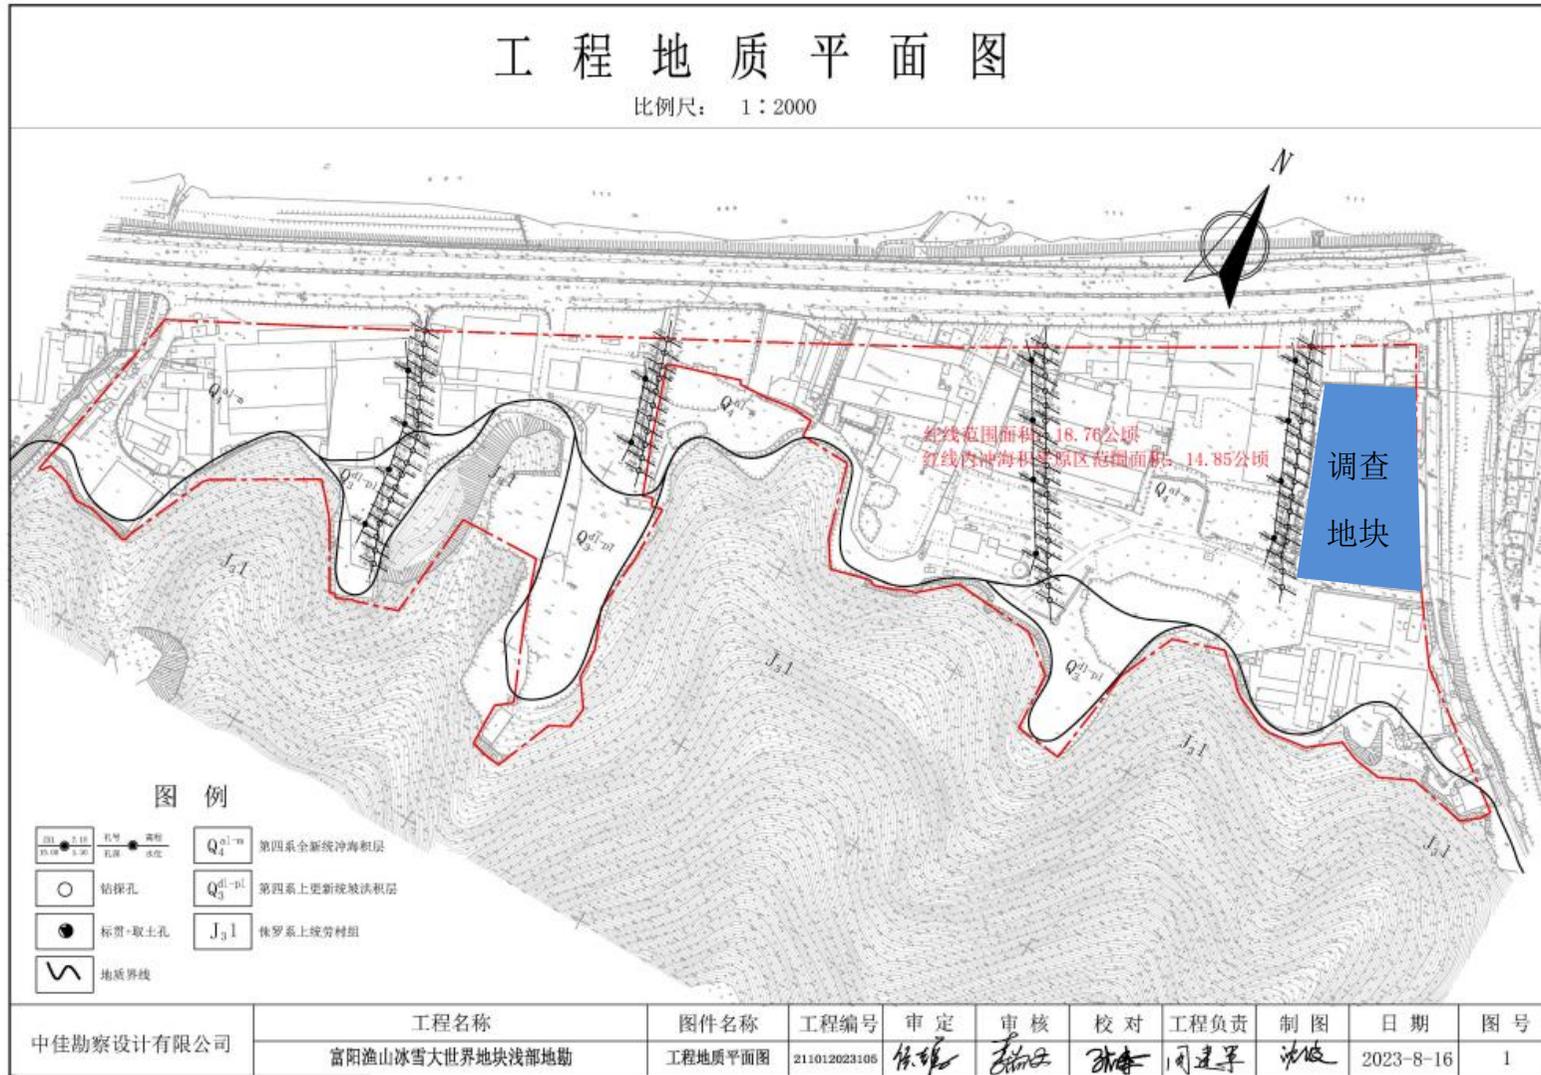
地勘报告的勘探点位平面布置图与本次调查地块的相对位置
